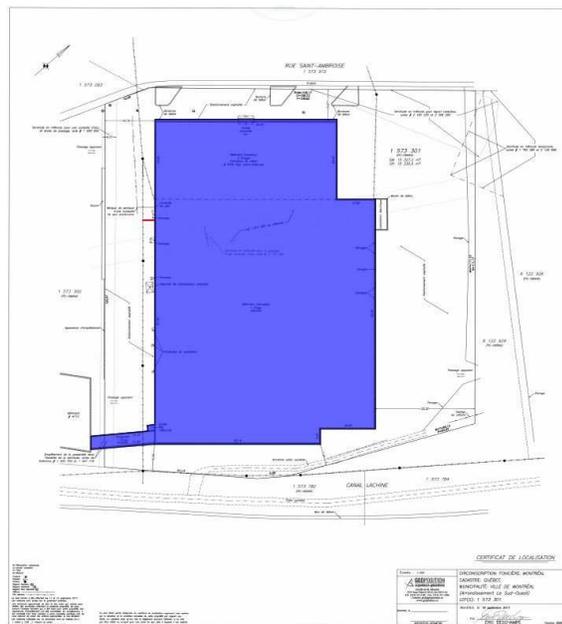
Surface de toiture avec poutrelles contaminées à retirer (en bleu)
